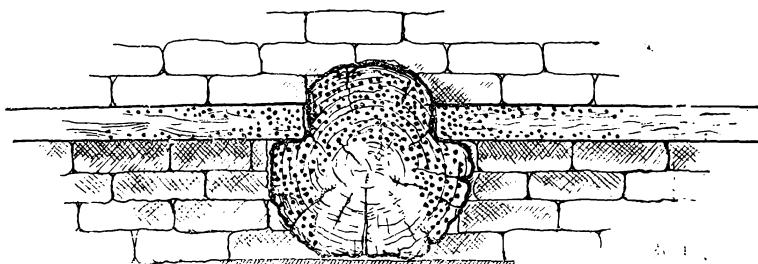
Поперечный разрез конца балки чердачного перекрытия, лежащей в гнезде наружной стены.
